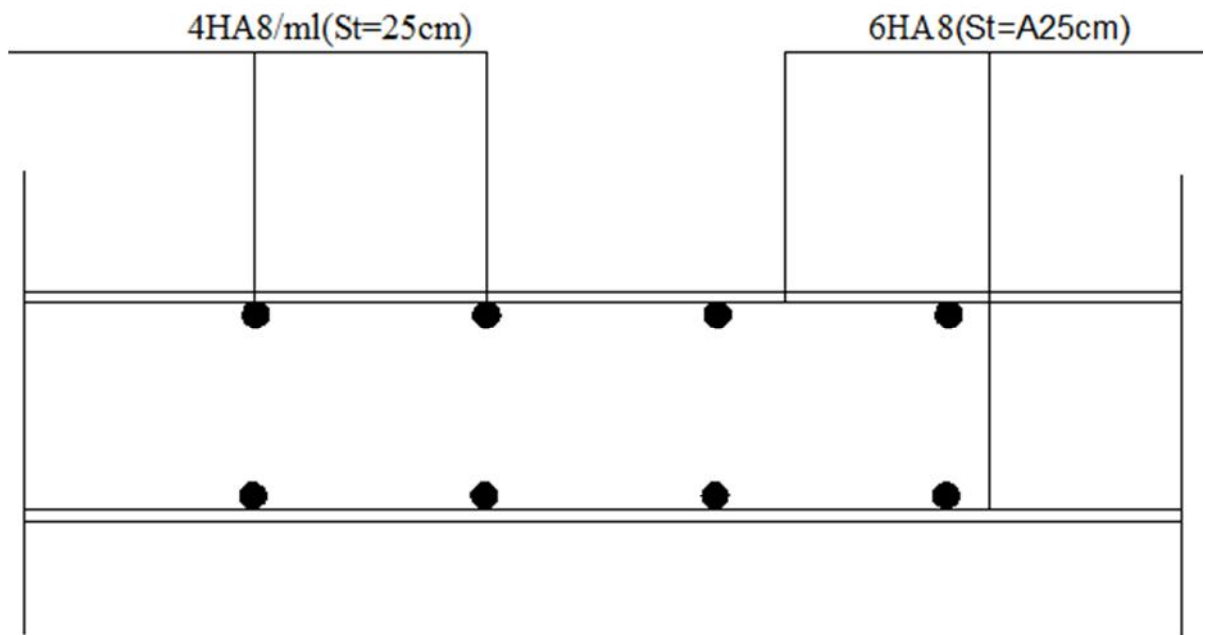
schéma de ferrailage de l'acrotère Coupe AA
